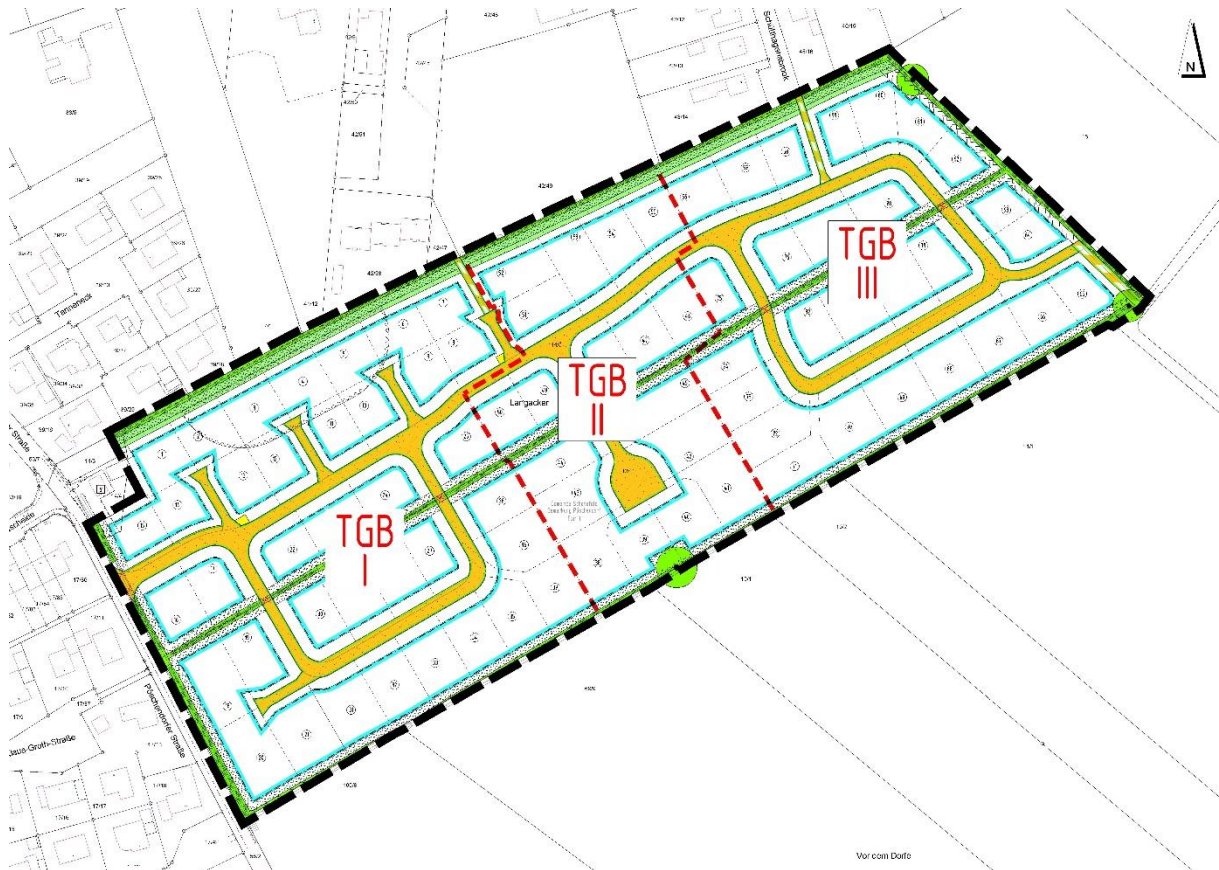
Übersicht Teilgebiete (TGB) Bebauungsplan Nr. 29 „Pöschendorfer Straße“
